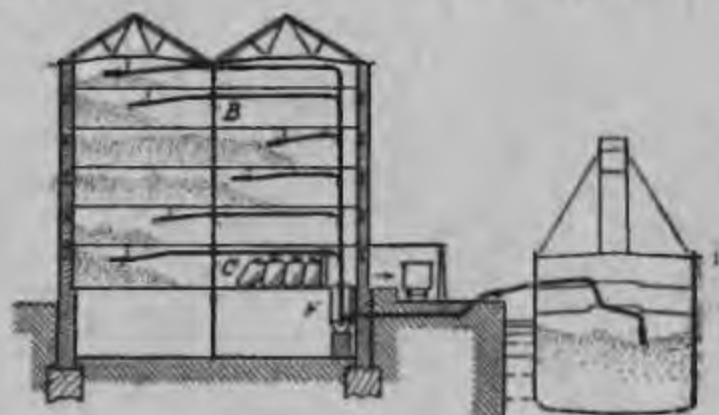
Схема пневматической установки для подъема зерна из судна в береговой склад нагнетанием.
